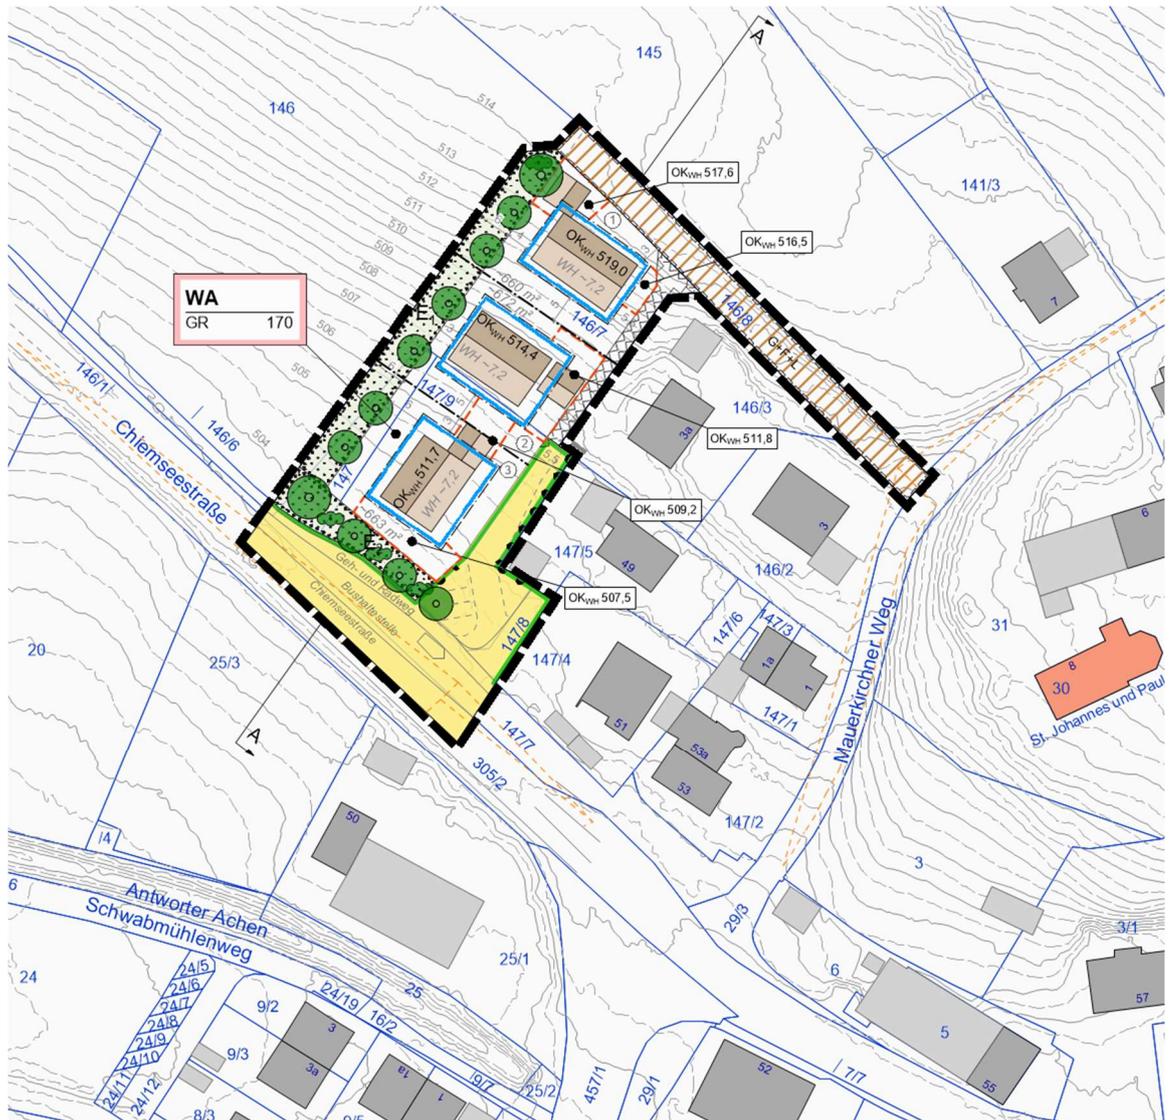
2. Änderung BP Nr. 49 „Mauerkirchen II“ – Entwurf, Stand 27.03.2024 - ohne Maßstab
